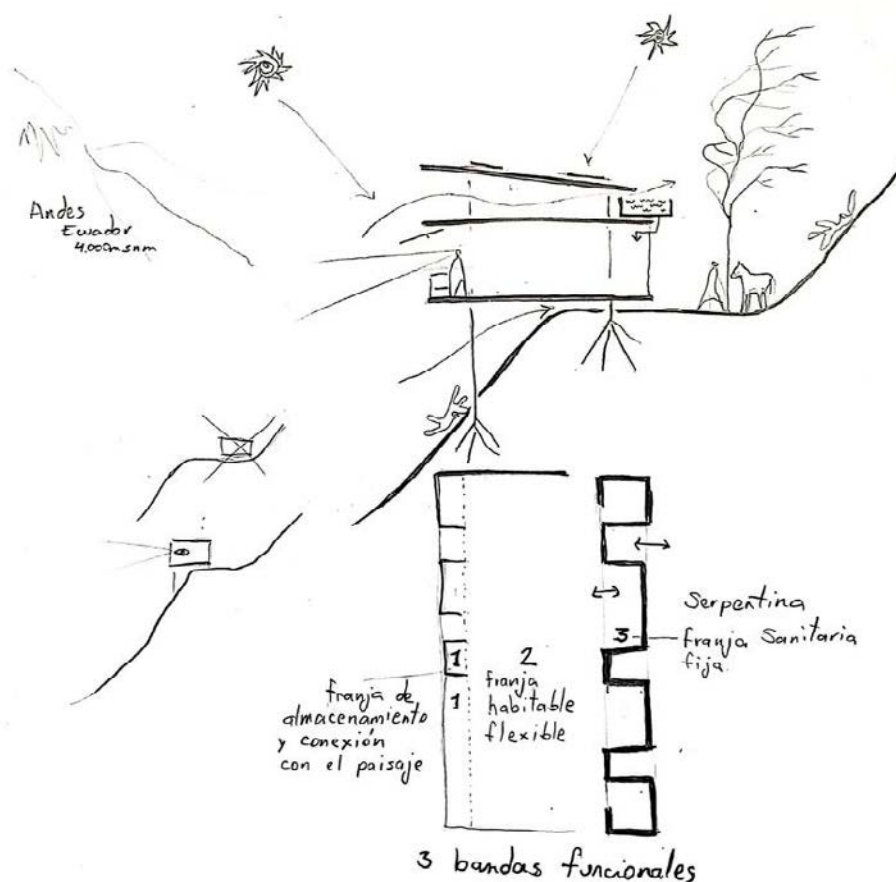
Partido arquitectónico, planta y sección: Casa de la Barrancaec. Holger Cuadrado 2023
